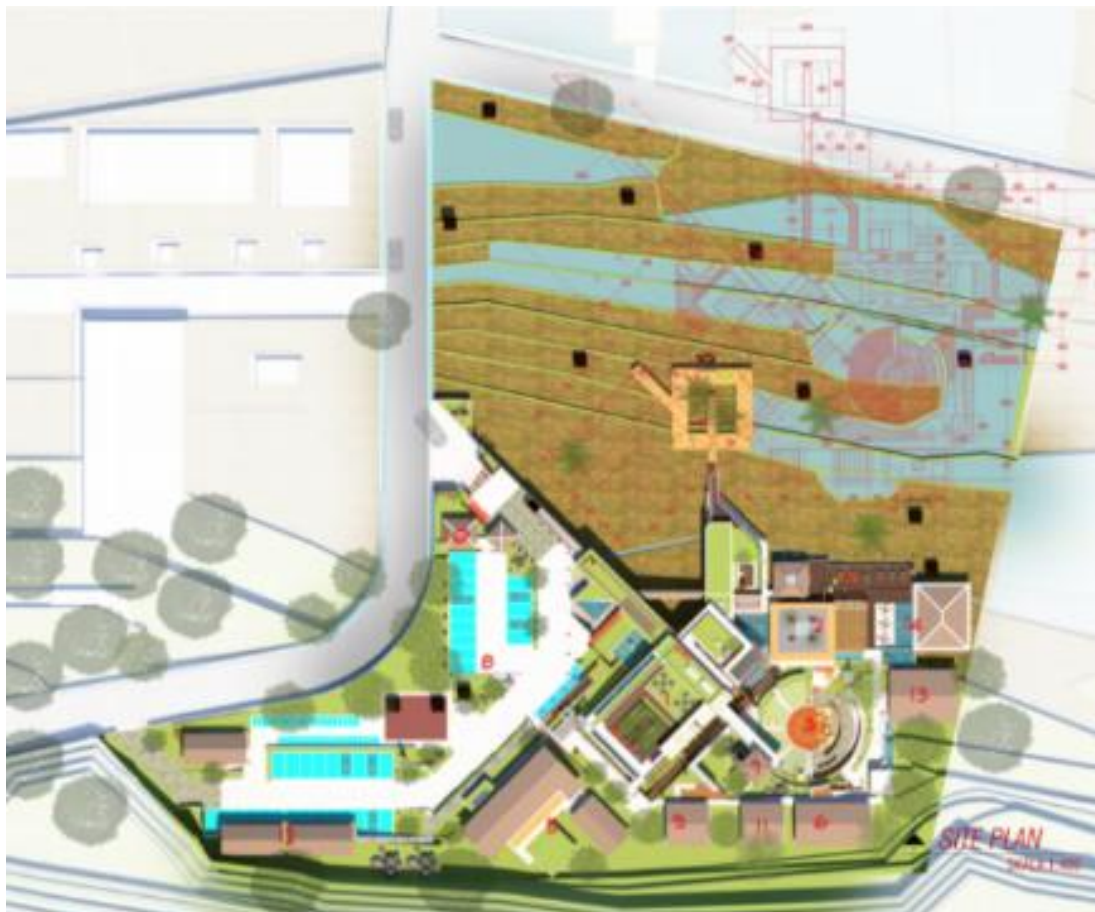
Konsep Konfigurasi Geometrik Bangunan
